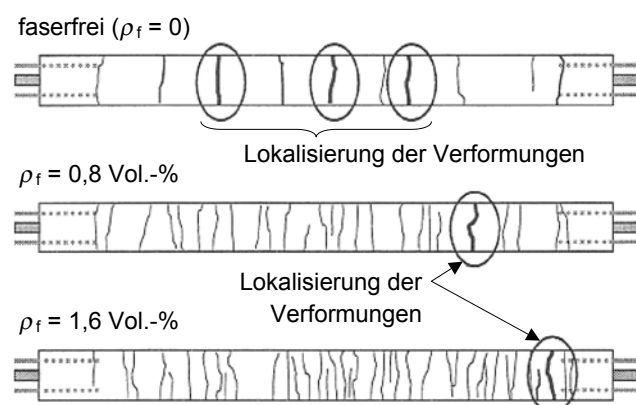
Rissbilder der zentrisch beanspruchten Zugelemente mit verschiedenen Fasergehalten [Wal06]
